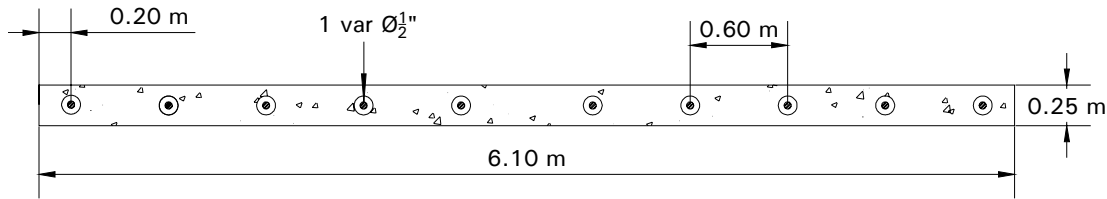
Sección transversal del muro en estudio de 6.10 m de longitud.
